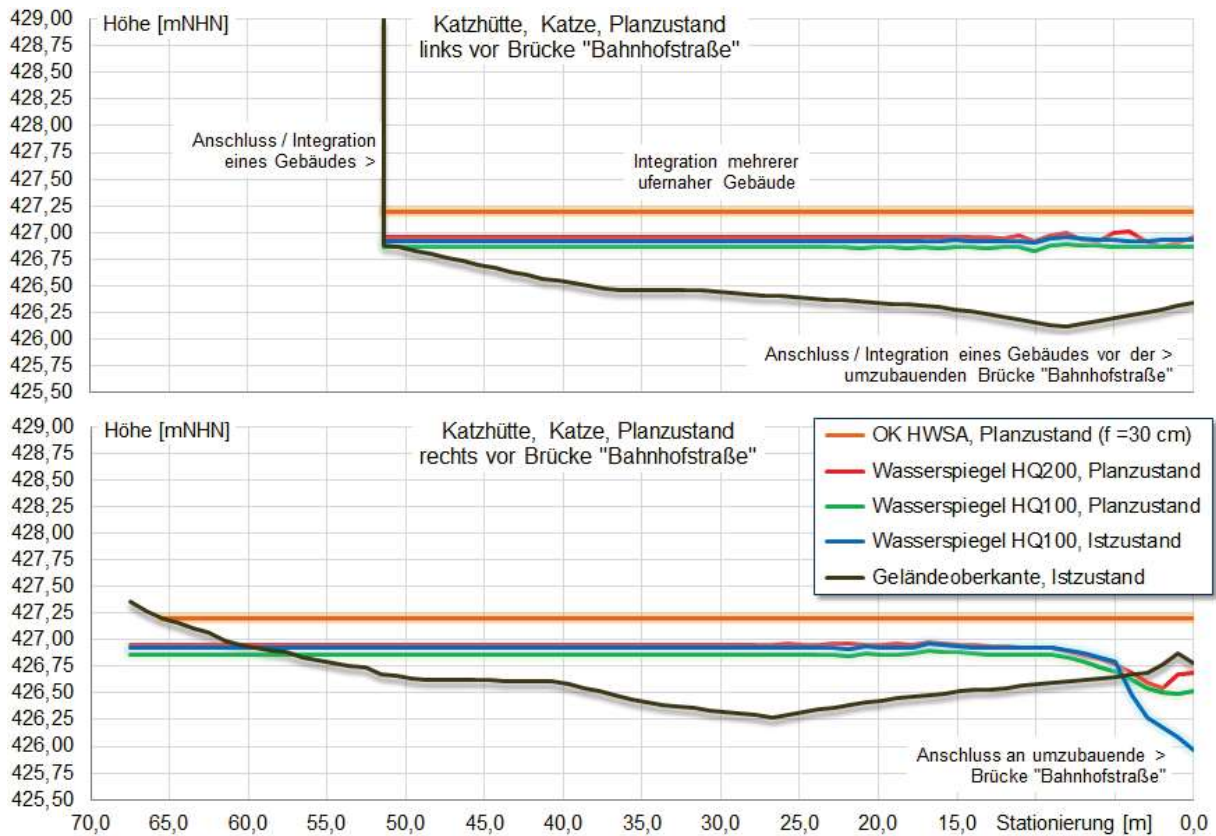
Katze-Mündung, Planzustand - Längsschnitte der Schutztrassen entlang der Katze vor der umzubauenden Brücke Bahnhofstraße
